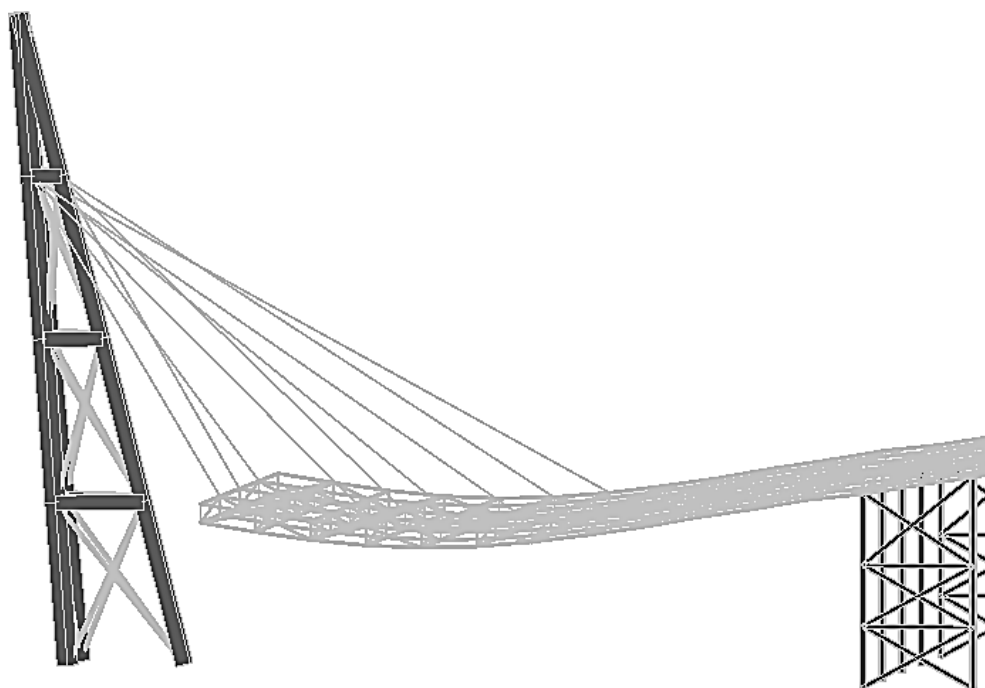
Конструкція пілона із залізобетонних колон
